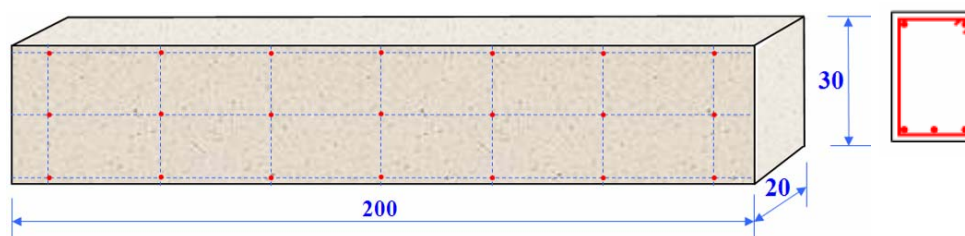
Ilustração da viga de concreto e dos pontos de malha da face
